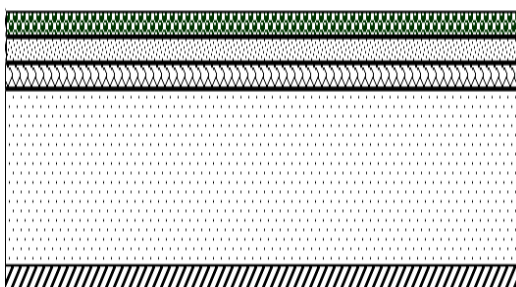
Coupe verticale du plancher courant à dalle pleine.
